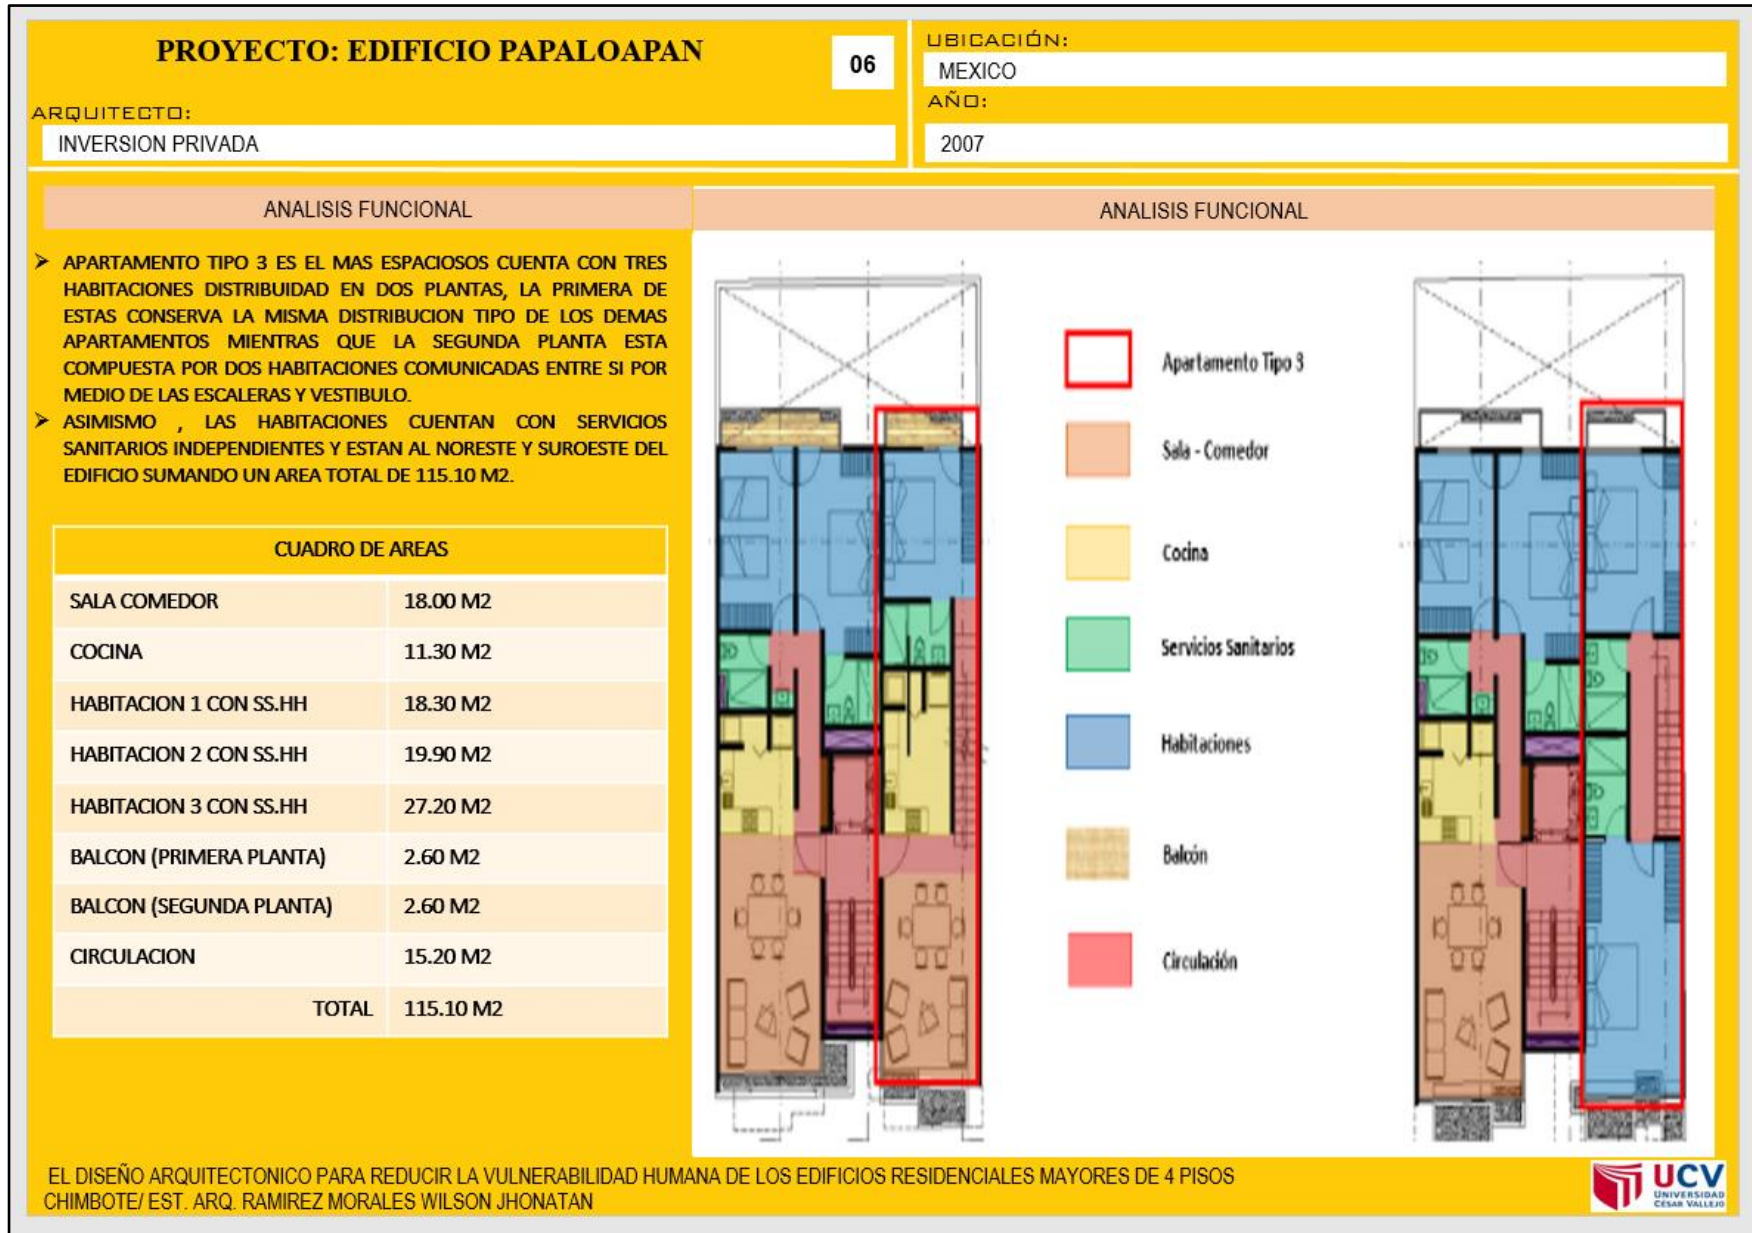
Proyecto: Edificio Papaloapan - 06
